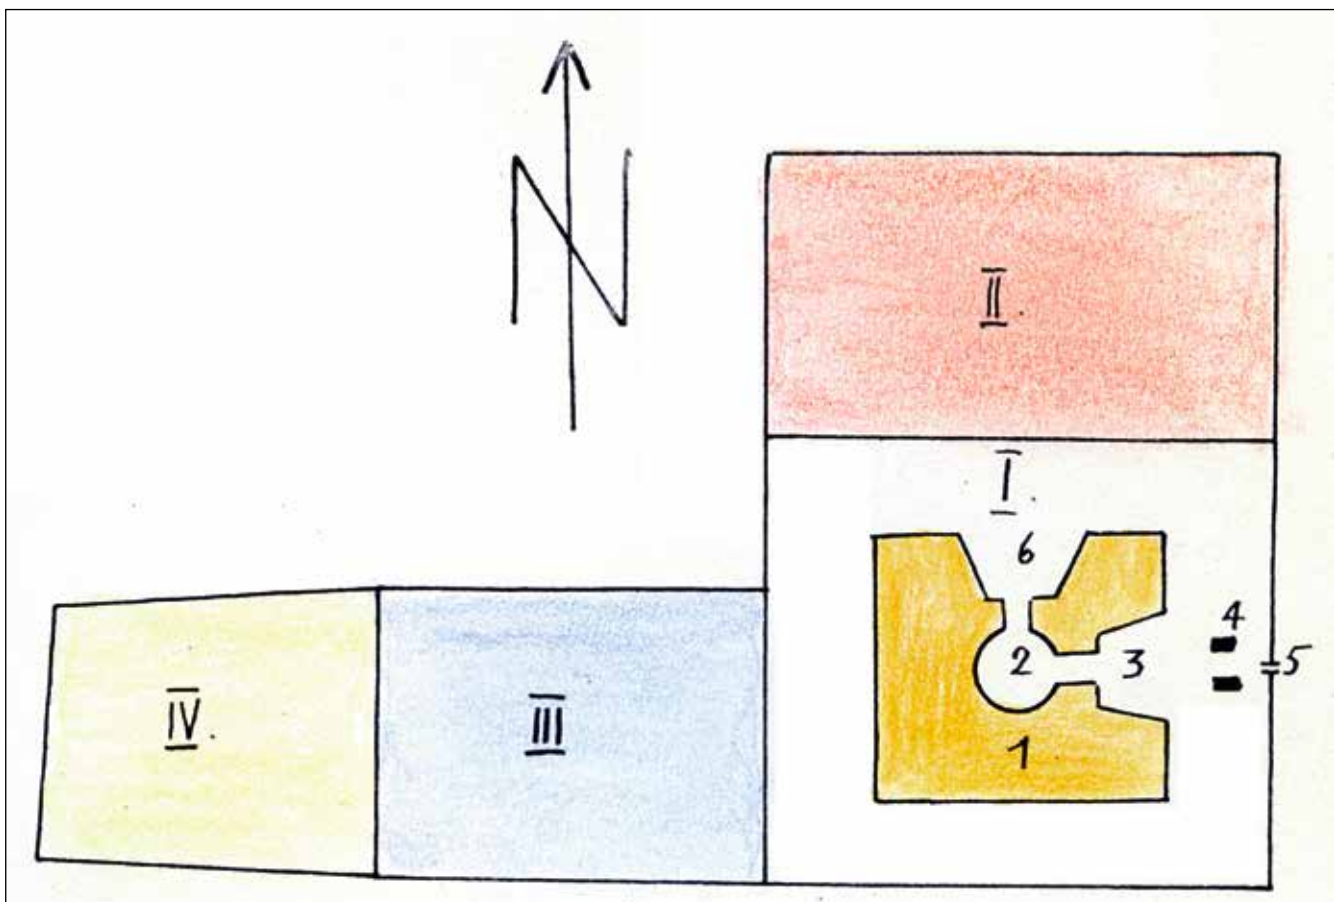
Grundriss des Hauses Rosales in Anderer. I Hauptgebäude mit Ofen, II Anbau, III Pächterhaus, IV ehemaliger Stall; 1 Ofenmauern, 2 Ofenschacht, 3 Windöffnung, 4 Lager für Blasbälge, 5 Öffnung für Wasserradachse, 6 Abstichöffnung.
